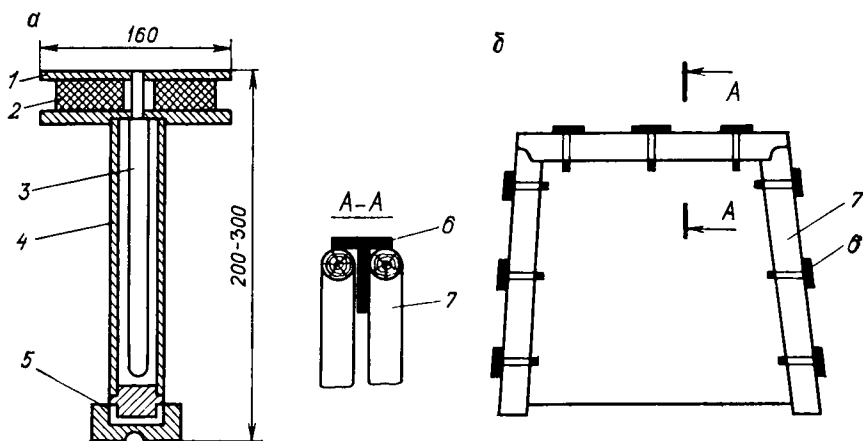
Схема замера горного давления динамометрами конструкции ЛГИ: а — динамометр; б — схема расположения динамометров в выработке: 1 — металлические диски; 2 — кольцо из вакуумированной резины; 3 — стержень; 4 — трубка металлическая; 5 — крышка; 6 — динамометр; 7 — стойка крепи
